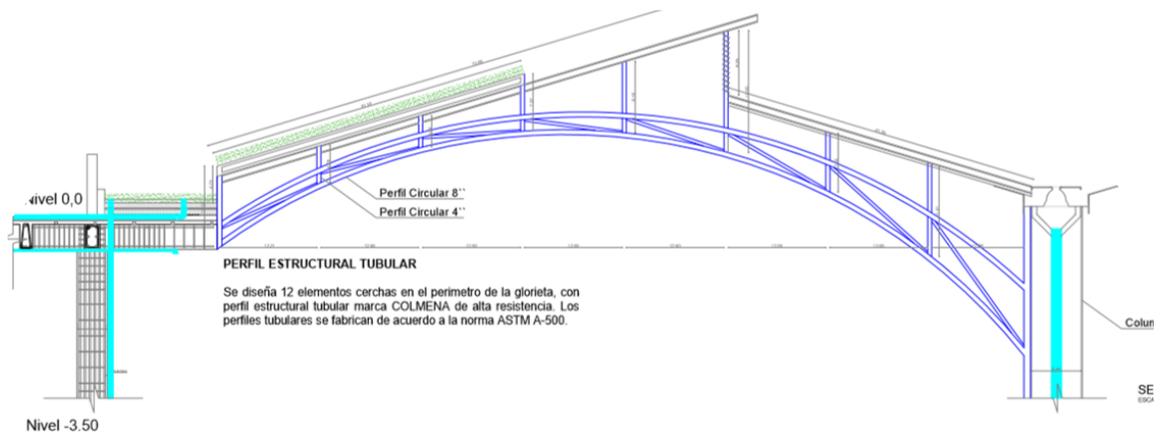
Detalle Cercha Metálica, Perfil Estructural Tubular
